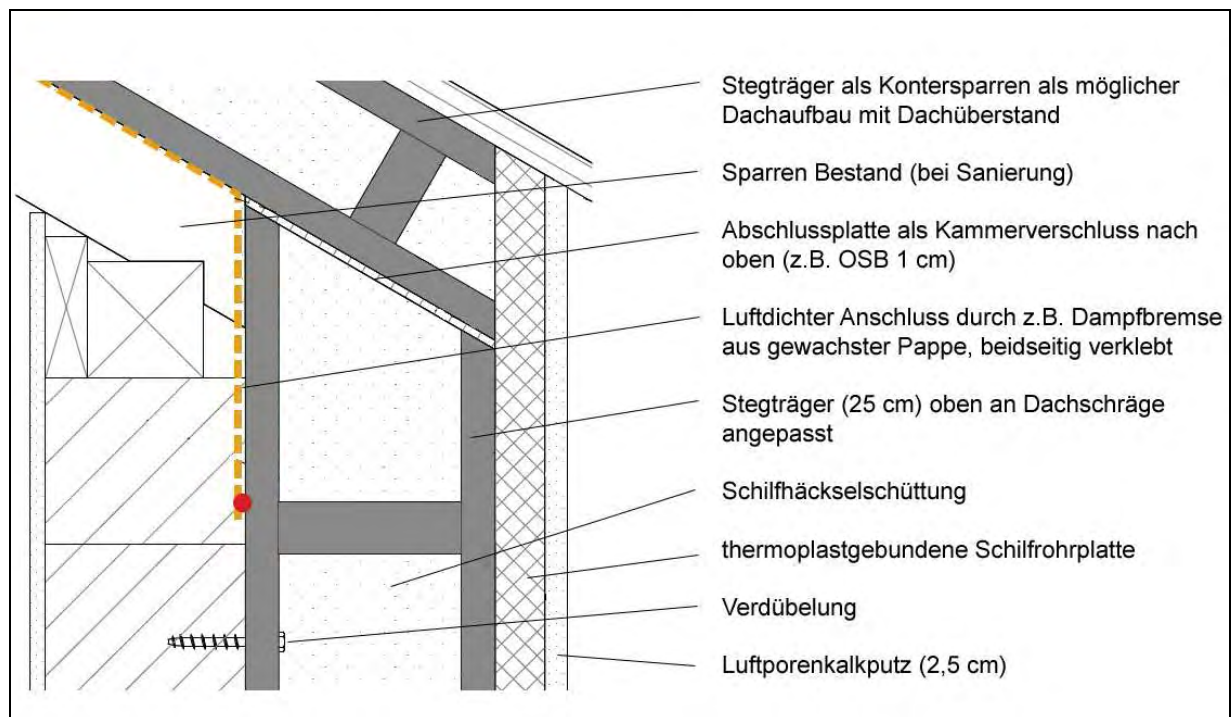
Dachanschluss der Stegträgerkonstruktion an einem Satteldach<sup>68</sup>
